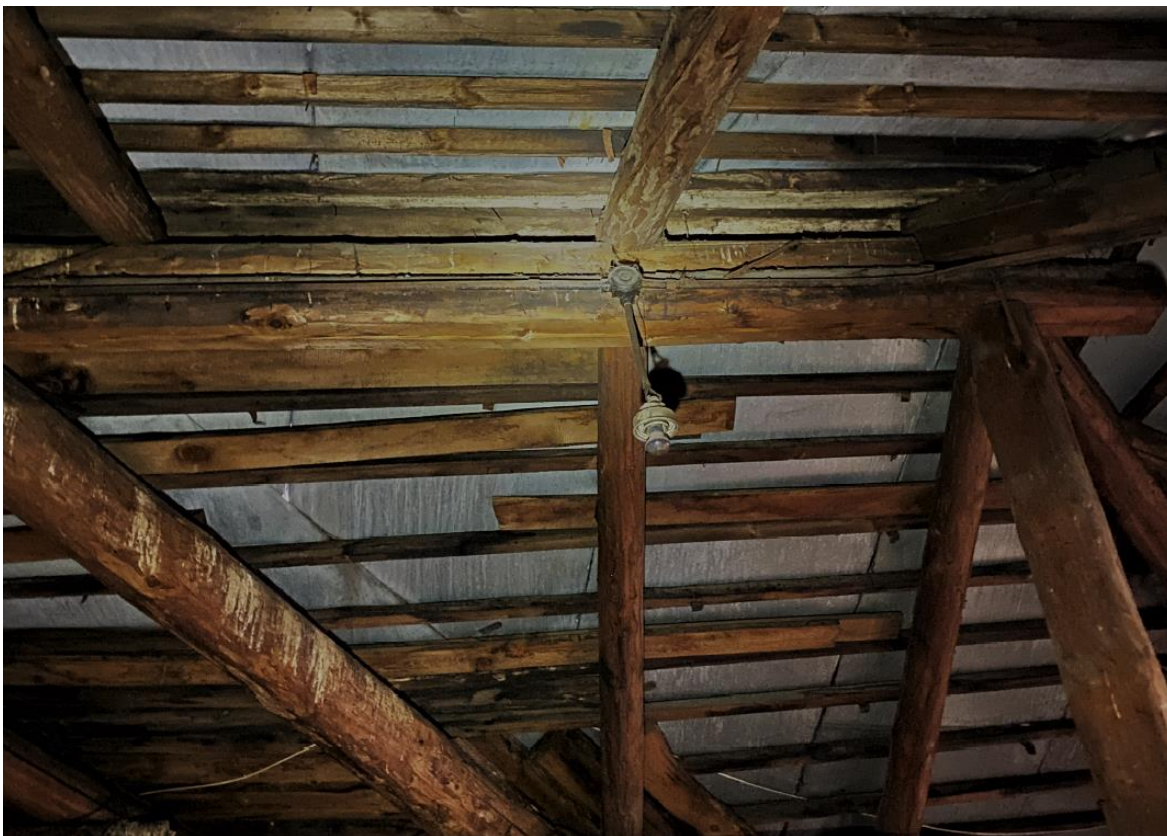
Фрагмент стропильной системы здания. Отсутствует плафон светильника.
